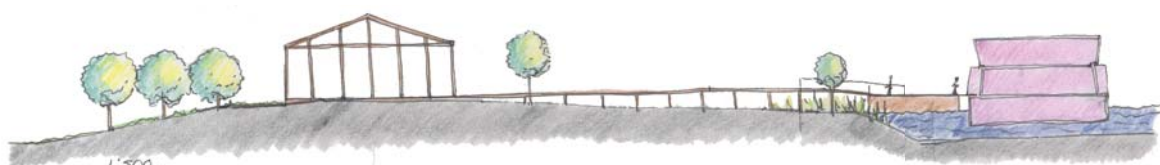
ponton Fast Ferry, Bij: auteur
